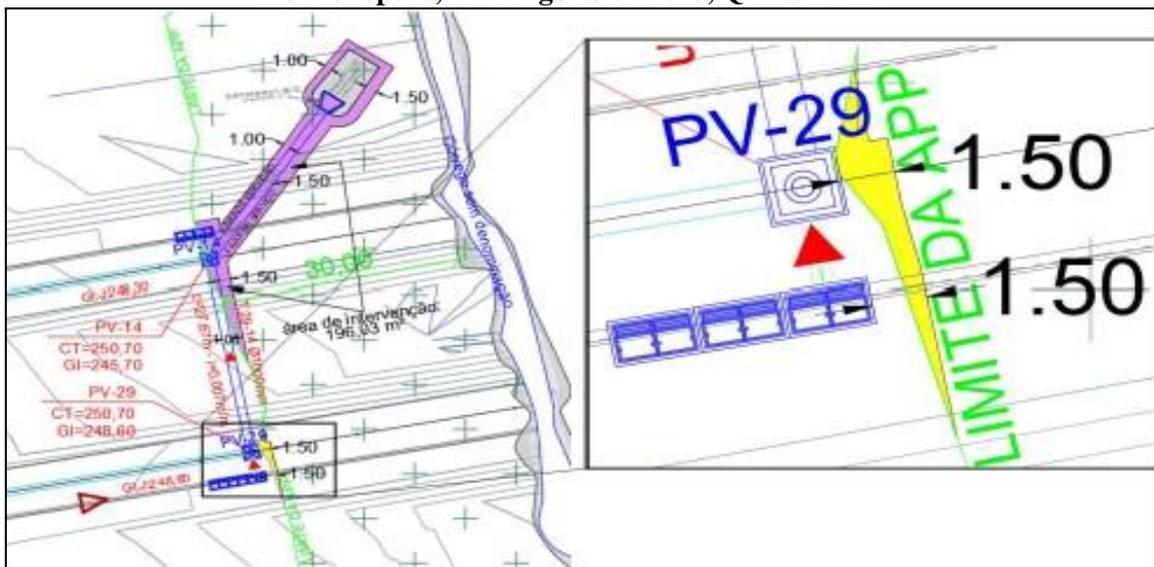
Planta de intervenção apresentada no Anexo II, focando área da hachura amarela (supressão de vegetação para trecho final da rede).
